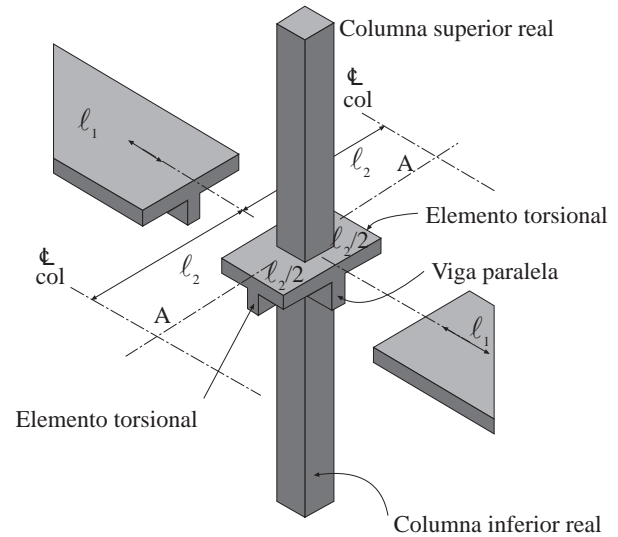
Columna equivalente (columnas más elementos torsionales).
